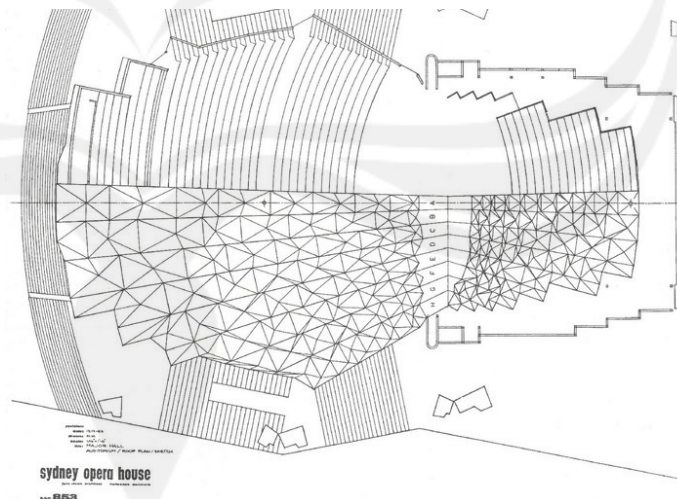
Ruang pertunjukan dengan Bentuk Lantai Tapal Kuda
